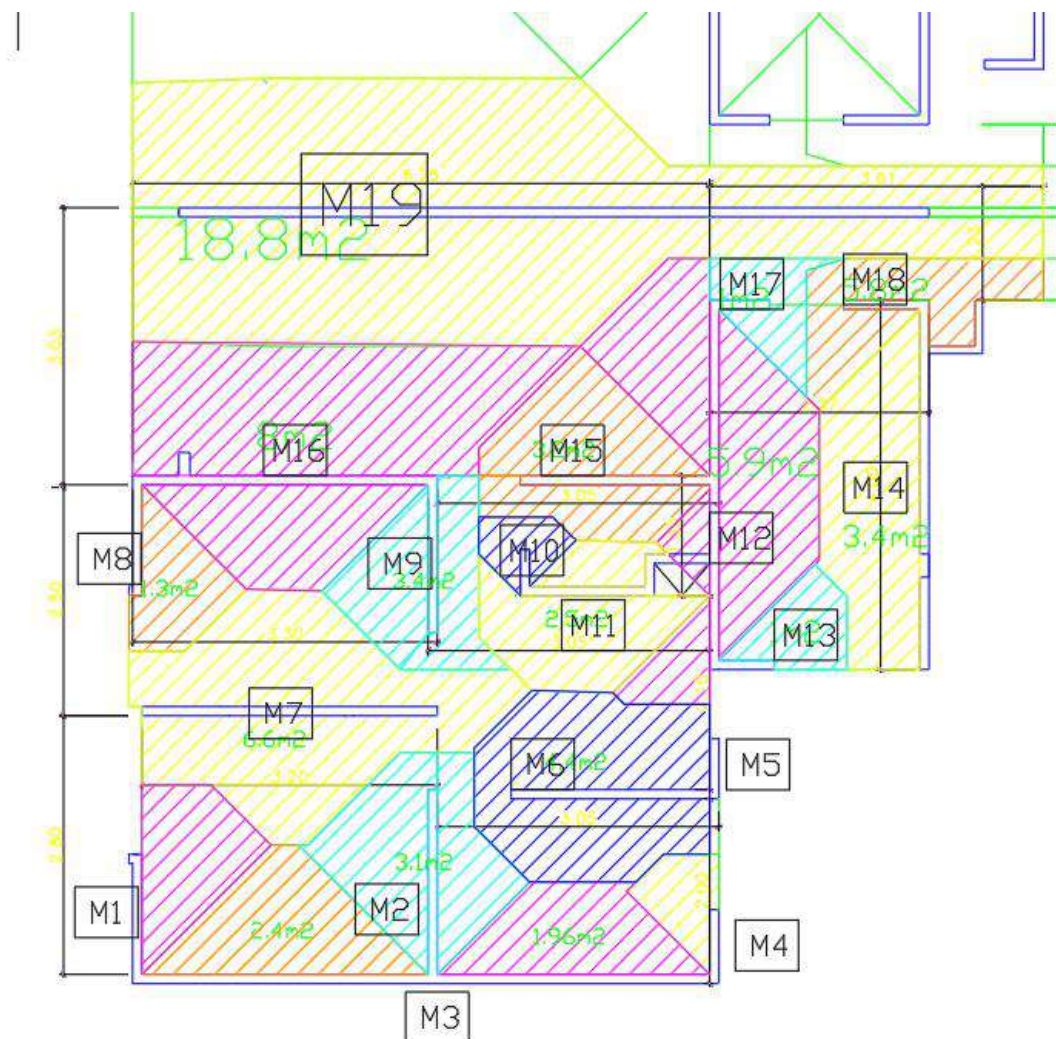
Plano en planta del trazo de áreas tributarias de los muros
